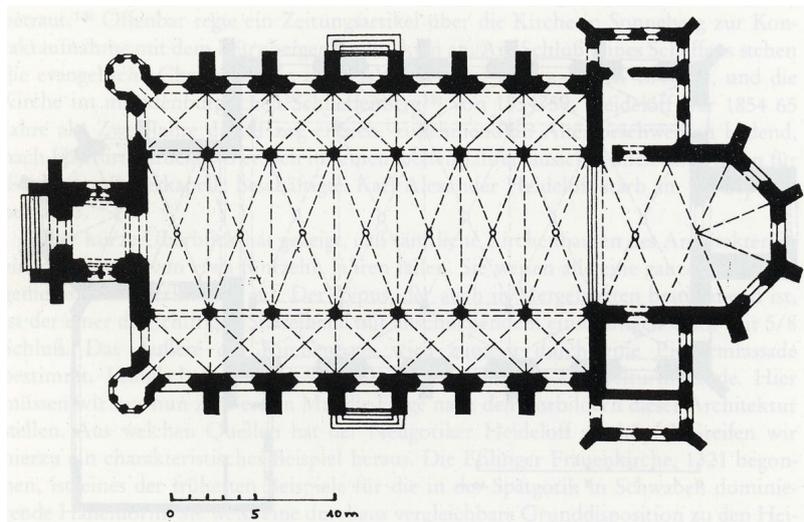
Sonneberg, ev. Kirche, Grundriß
